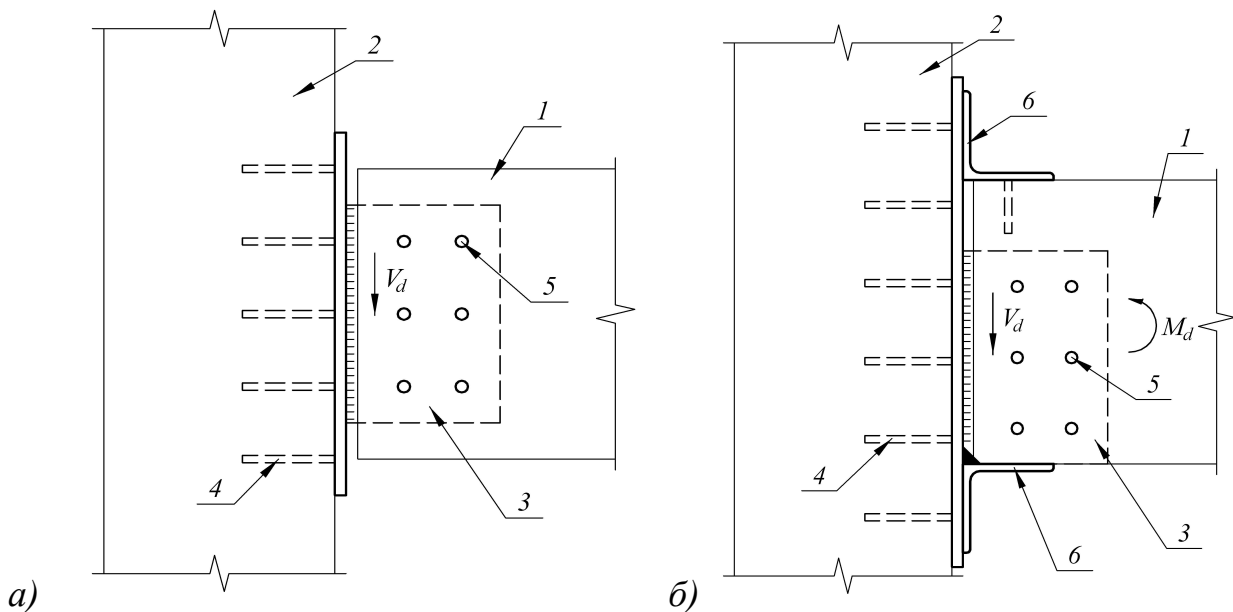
Загальний вигляд конструкції вузлів сполучення клеєної дерев'яної балки та колони: а) шарнірний; б) жорсткий; 1 – балка; 2 – колона; 3-Т-подібний зварний елемент; 4, 5 – болти; 6 - кутники
